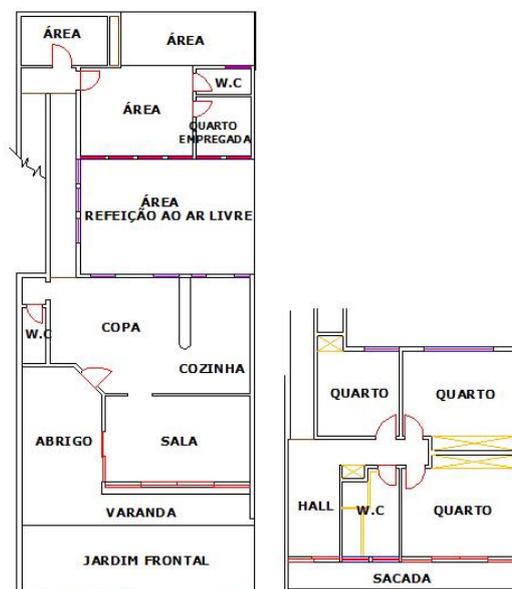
Croqui Planta Original – Res. Alfredo Fonseca
